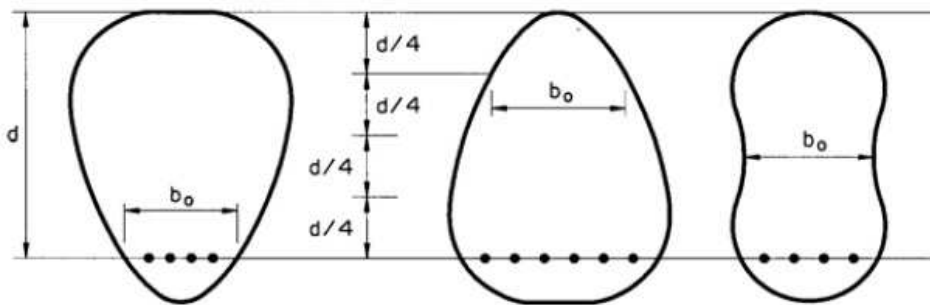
Parámetro b_o cuando la anchura de alma no es constante
